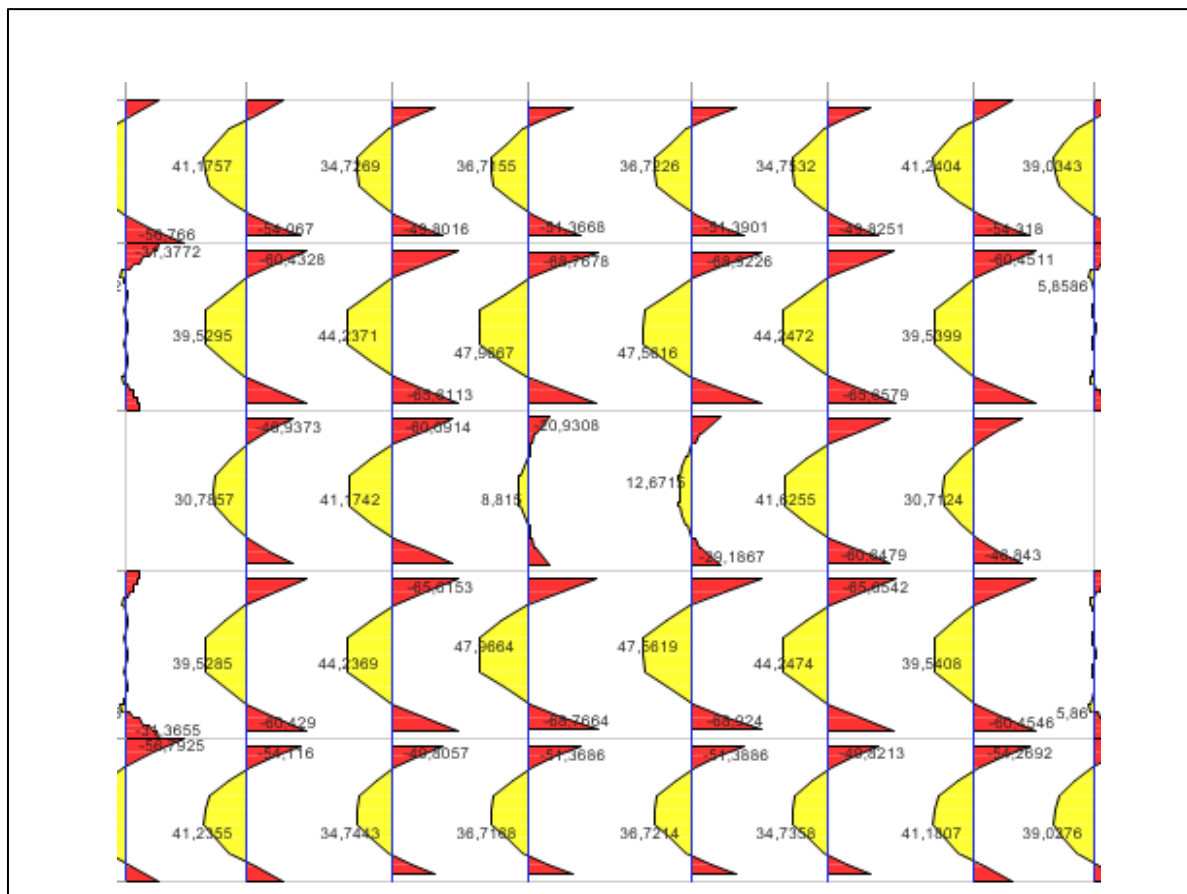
Moment fléchissant des poutres principales (ELU)
